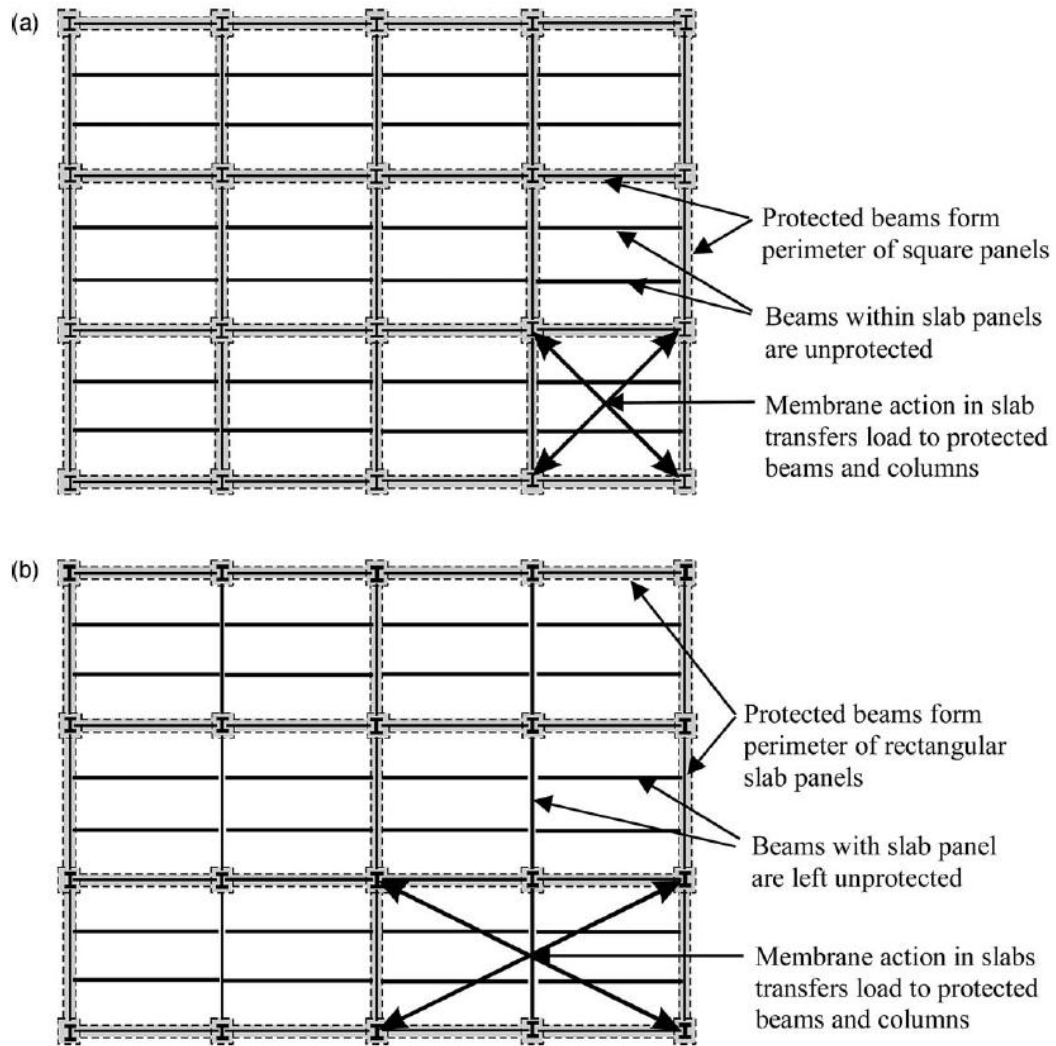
Division d'un plancher en panneaux [BAI 04a]
